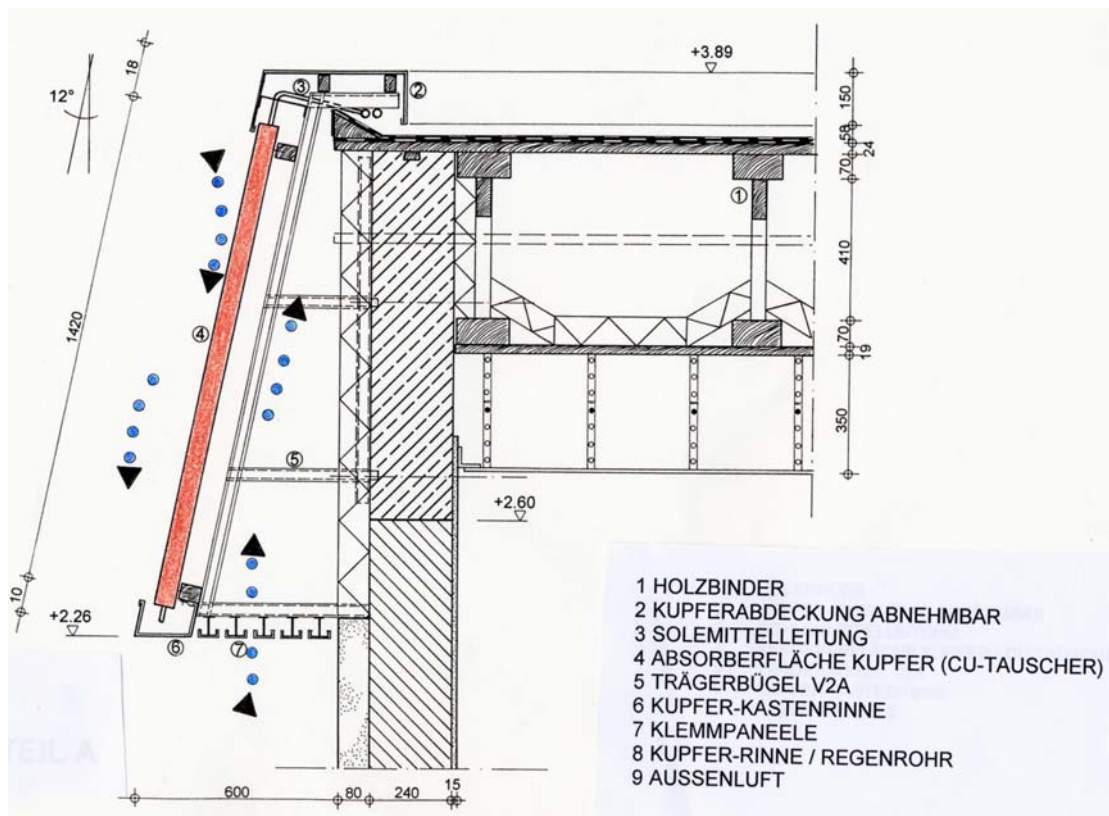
Längsschnitt der Blende mit Dachkonstruktion (unmaßstäblich), VEW AG, BD/DO, Abt. Bautechnik
